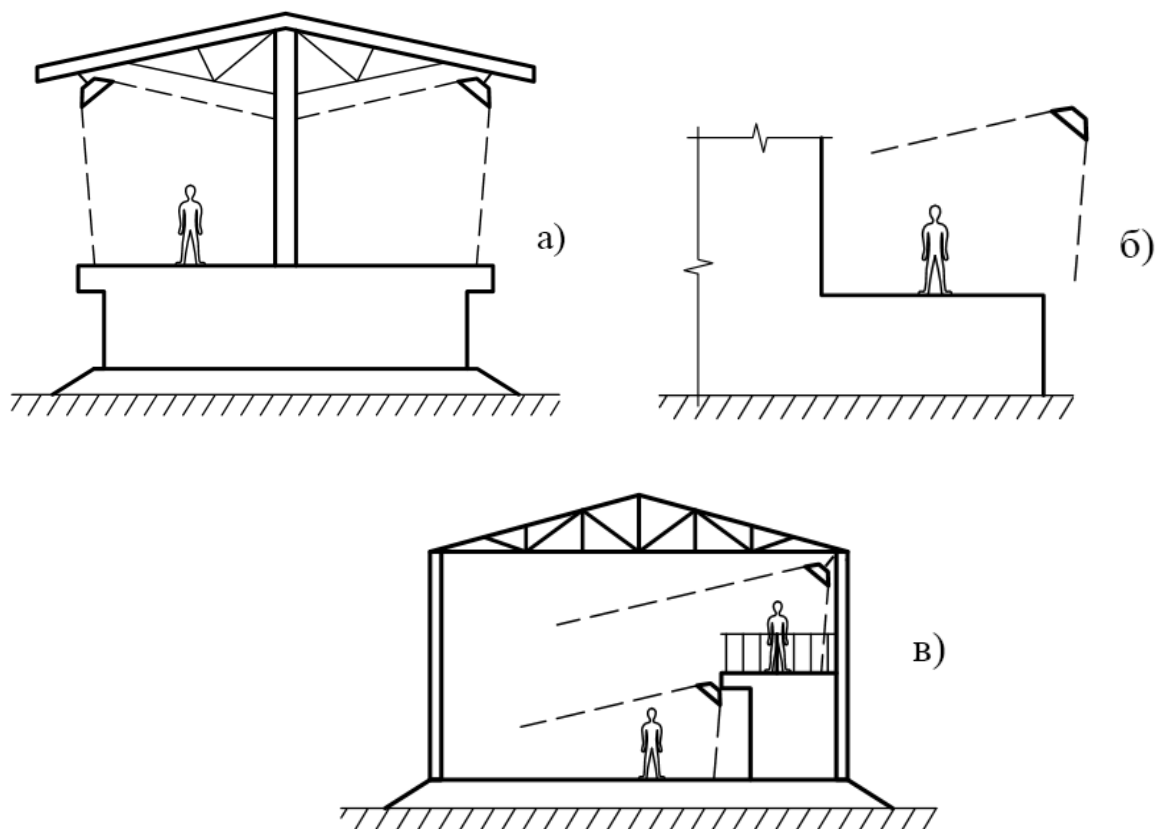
Схемы локального обогрева открытых и полуоткрытых площадок с использованием инфракрасных газовых нагревателей: а – под навесом; б – на пандусе; в – на двух уровнях в полуоткрытом помещении
